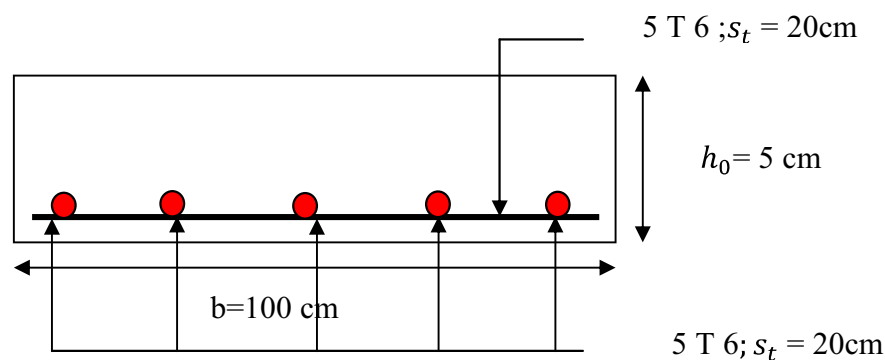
Le schéma de ferraillage de la dalle de compression
